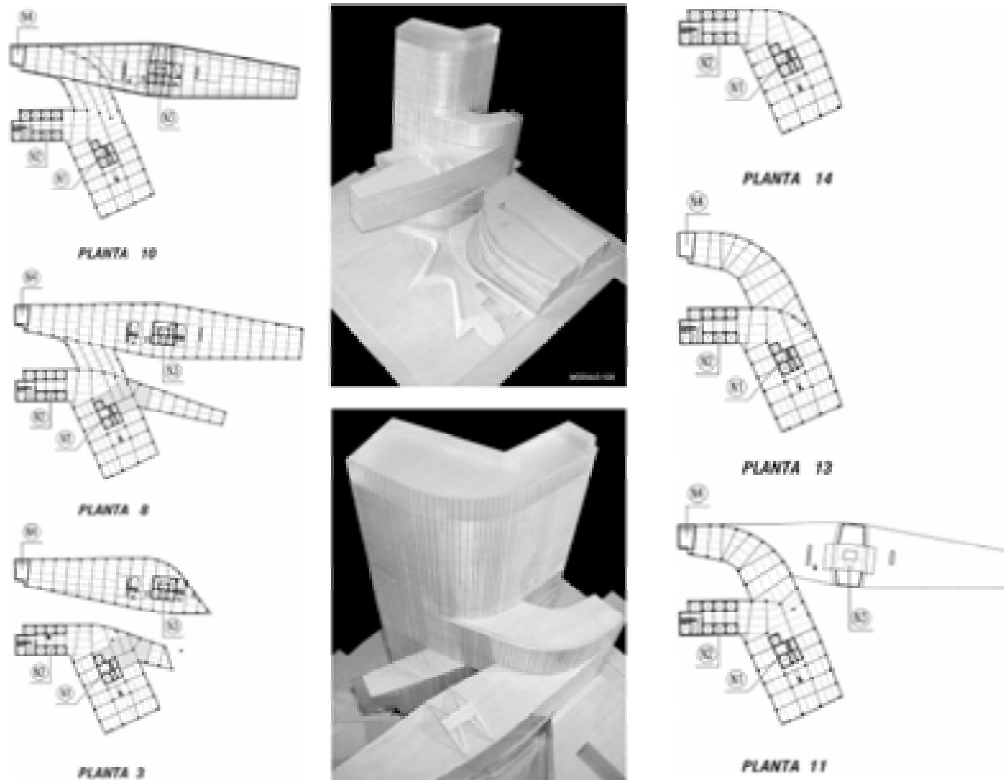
Secuencia de algunas plantas y fotos de la maqueta arquitectónica.
